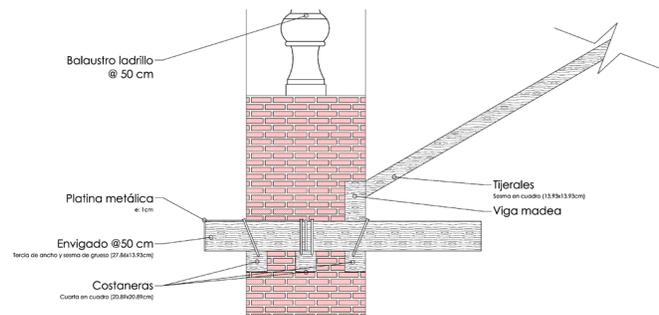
Detalle encuentro techumbre con muro. Elaboración propia en base a Montandón, 1980
